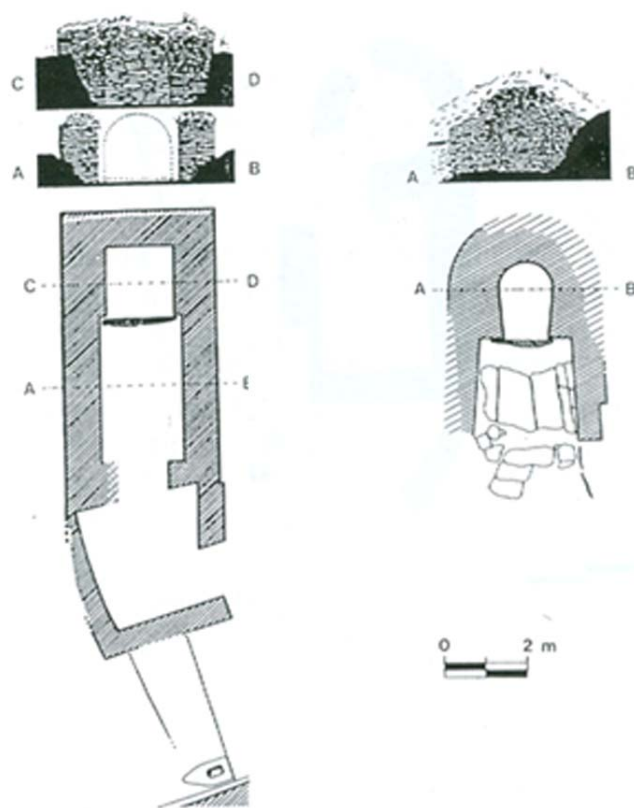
Planta y secciones de las «saunas» de Pendia 1 y 2 (García Bellido, 1968).
